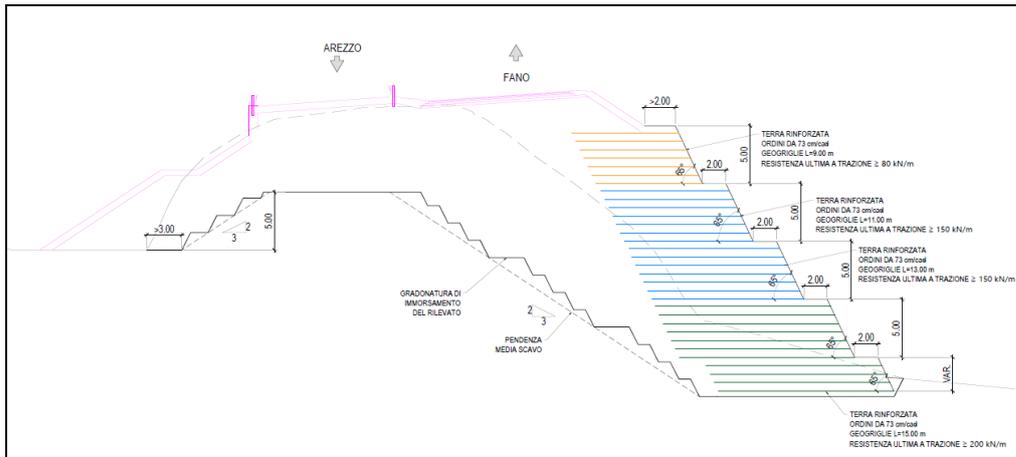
Sezione schematica del rilevato in terra rinforzata dalla pk 1+980 alla pk 2+110
